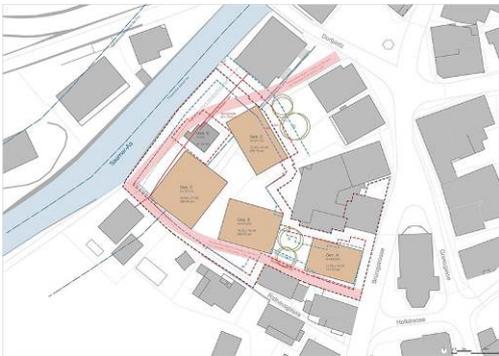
und 132: Testentwurf Varianten 4 / 5 «Bebauung mit Erhalt Gebäude Parzelle 20 / [und 98]» [Quelle: CCTP]
